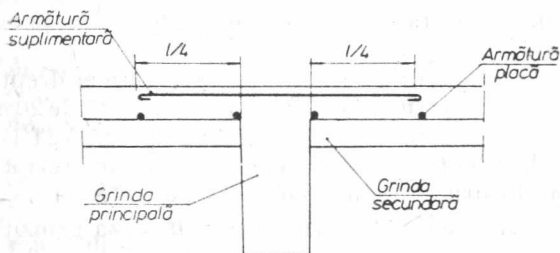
Armare suplimentară la grinzile principale ale planșeelor.
